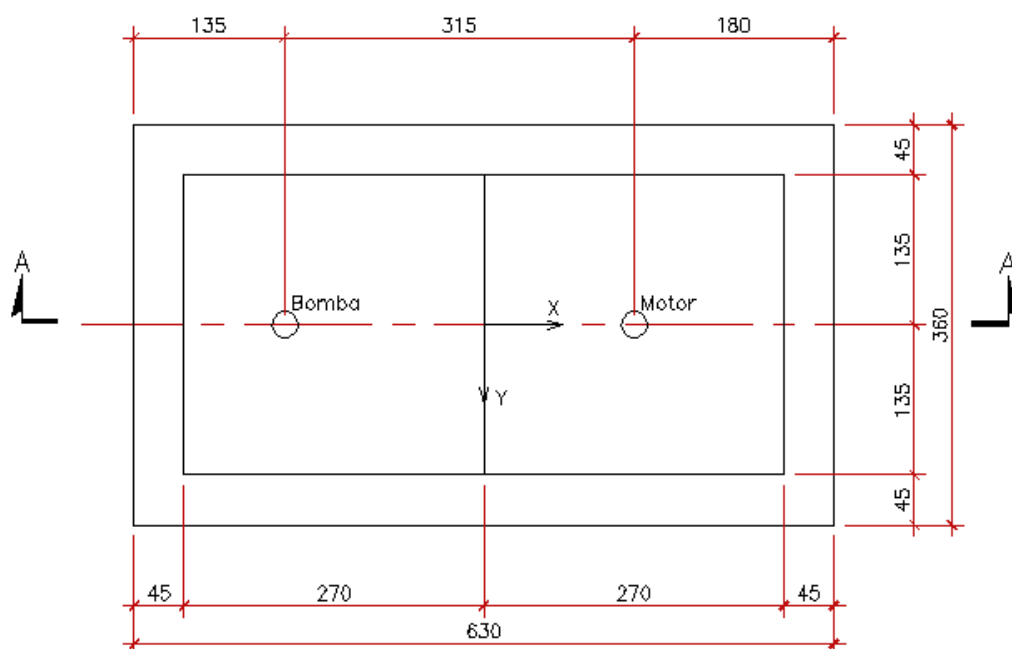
Planta da estrutura com dimensões em centímetros (cm)
